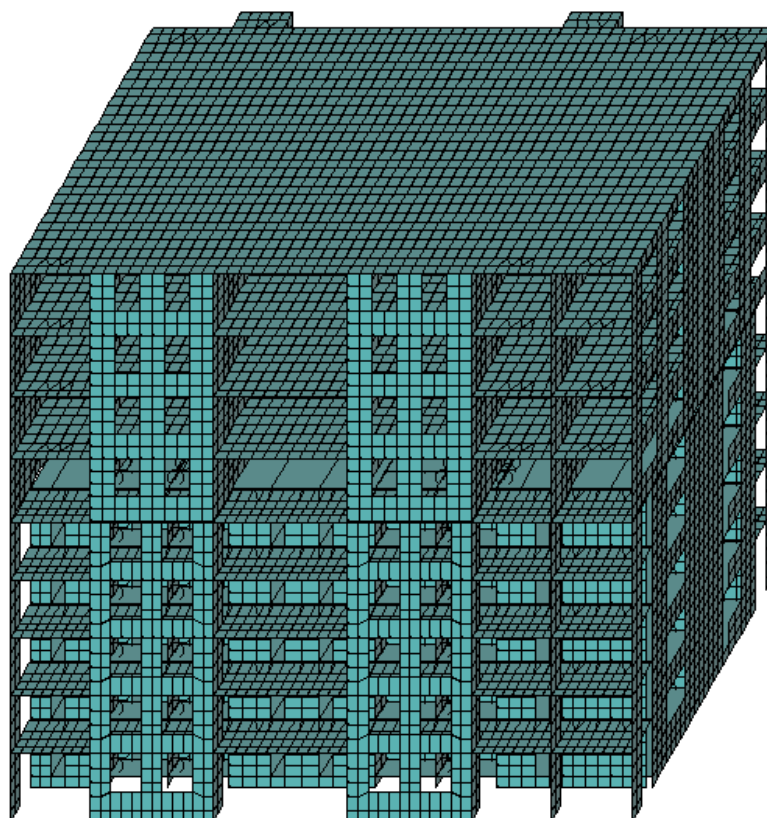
Расчетная модель исследуемого крупноблочного здания с надстройкой из монолитного железобетона.
